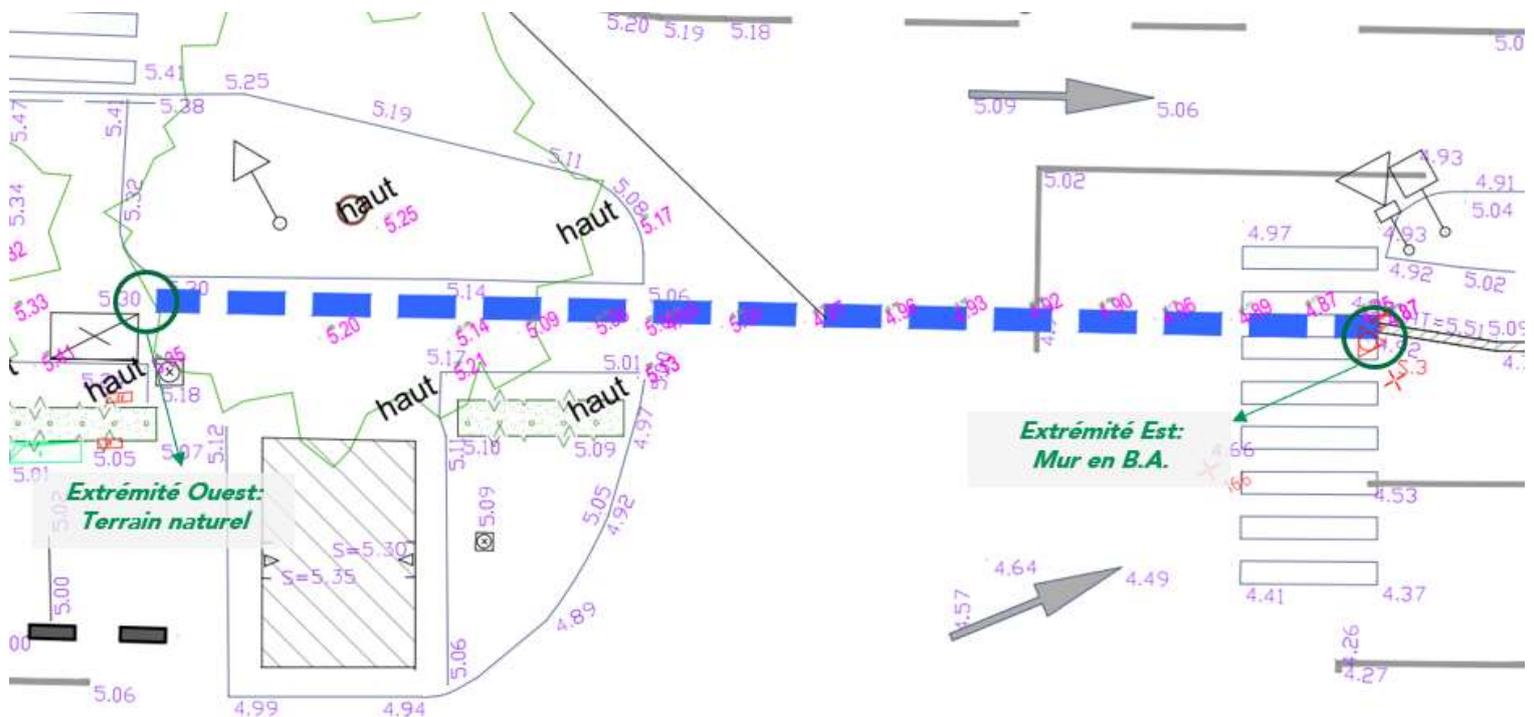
Linéaire 1 – protection amovible – vue en plan
